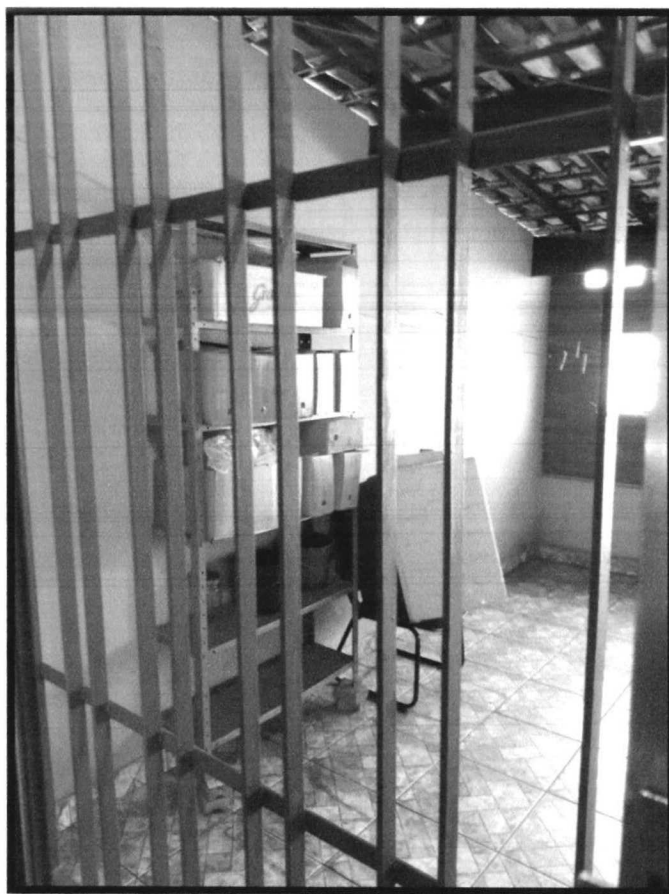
Área sobre garagem, vista a partir do dormitório nº 2
